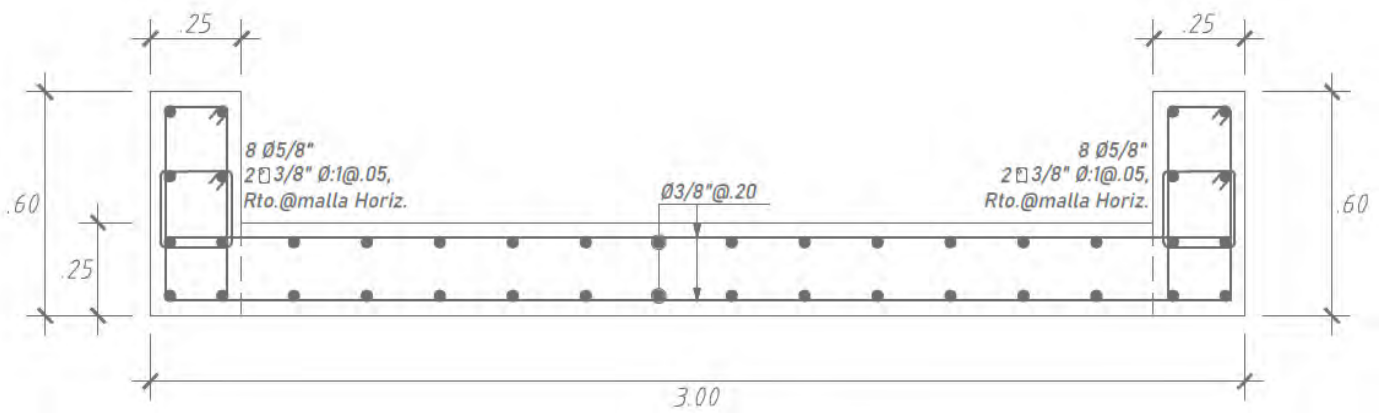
Diseño final de la placa PL-3 (primer piso)
